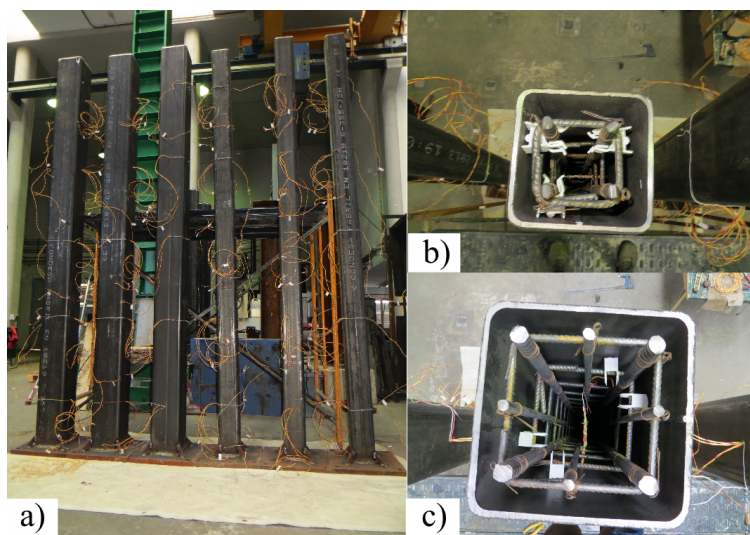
Instrumentação final das colunas: a) Vista geral dos tubos; b) Secção de 150mm de lado; c) Secção de 220mm de lado.
